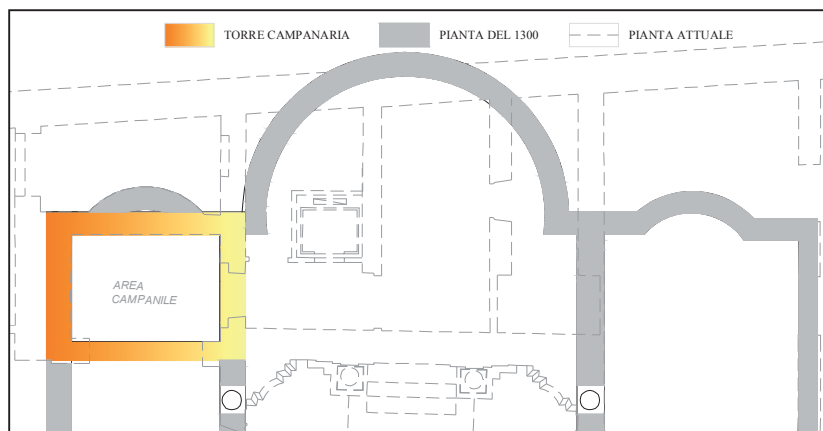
Sovrapposizione tra la pianta originaria e la pianta attuale con localizzazione della torre campanaria.
